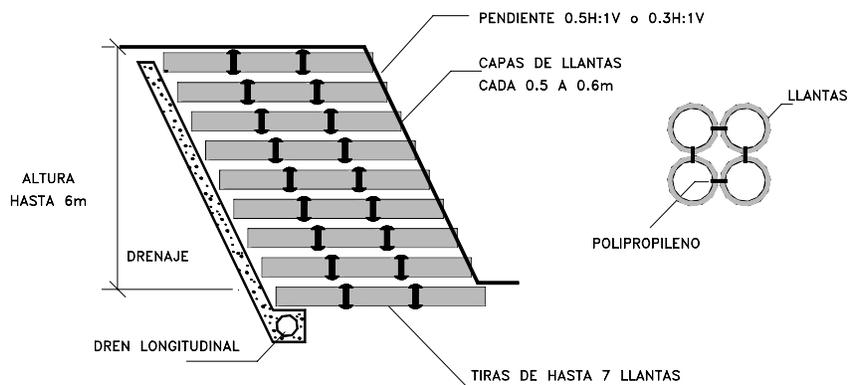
Esquemas de un muro en llantas usadas con arreglo total en las llantas (Hausmann,1992).
